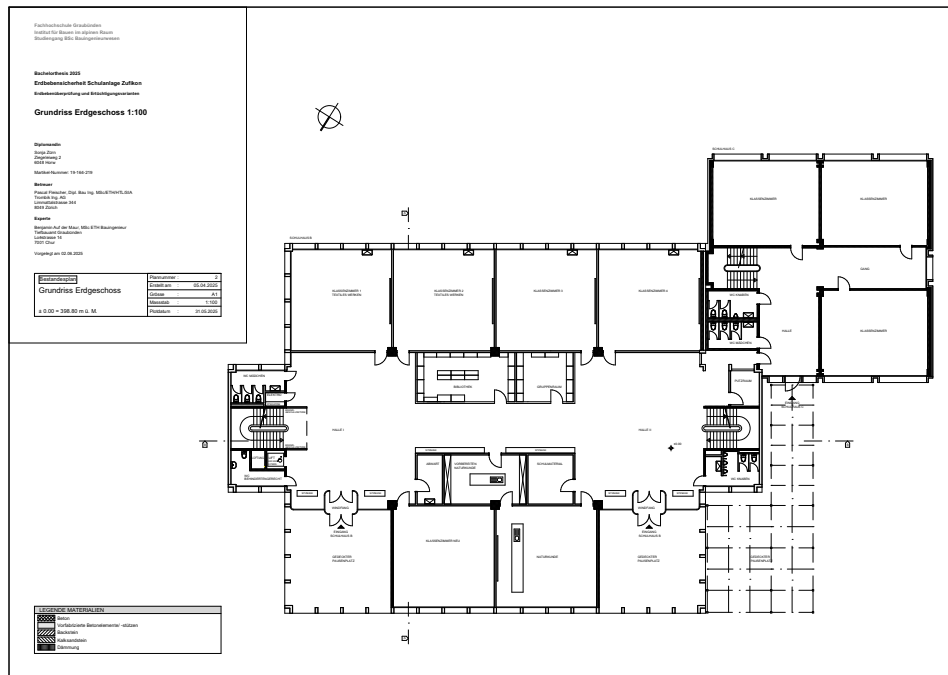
Grundriss Erdgeschoss Bestand
